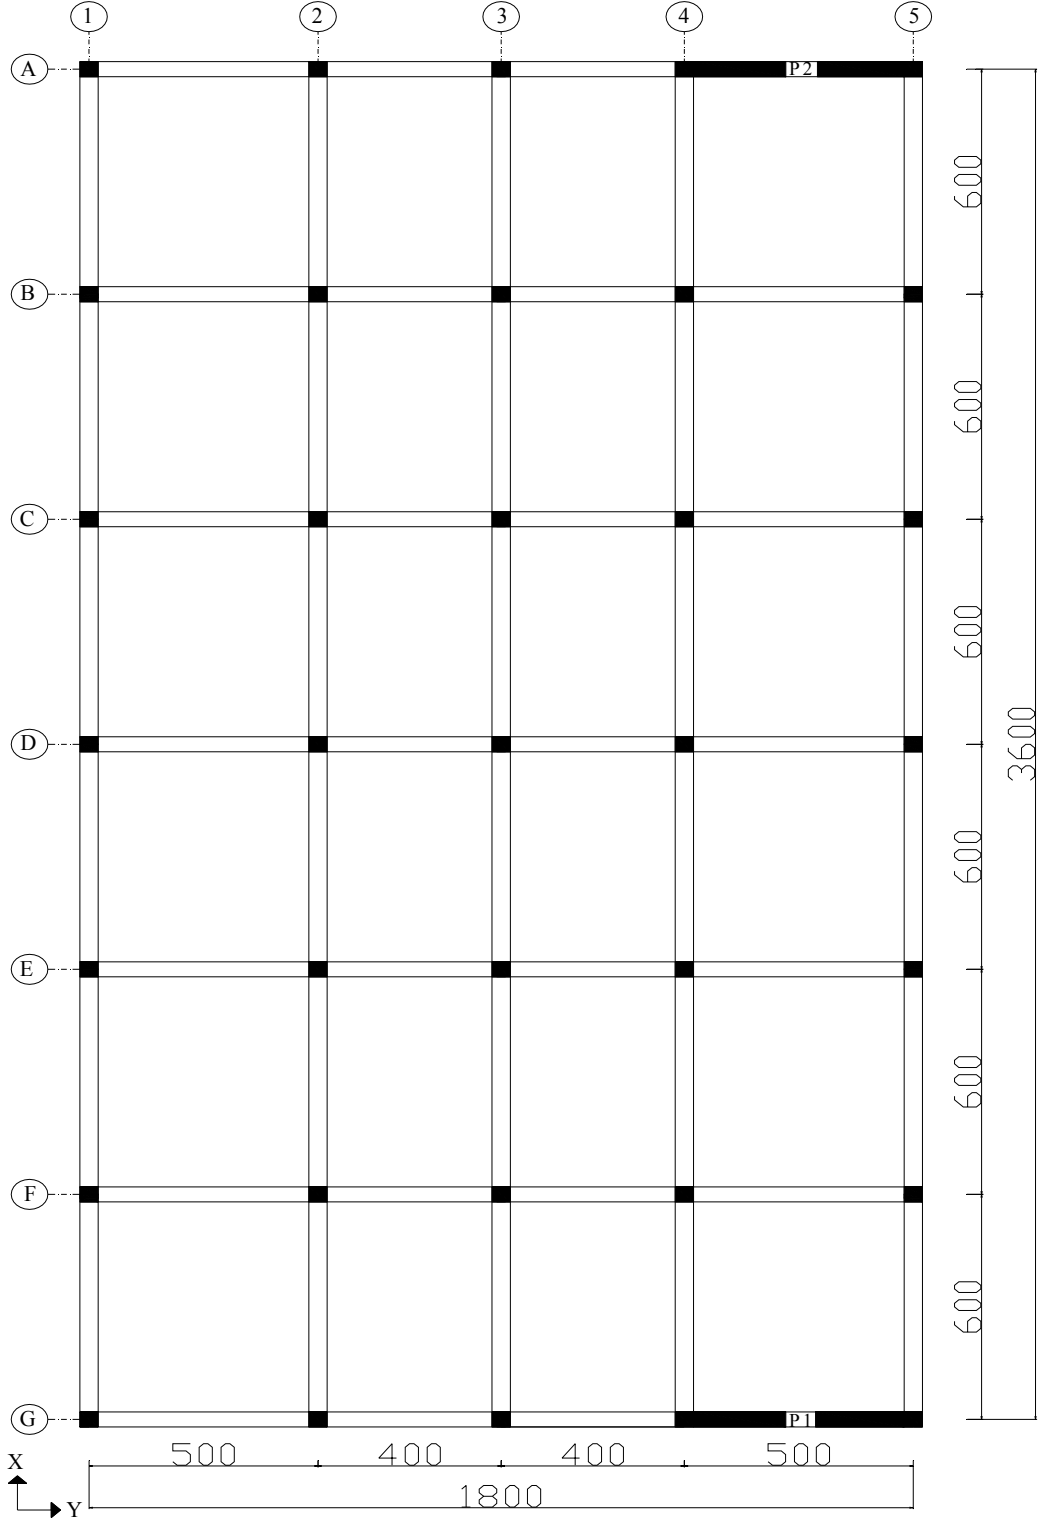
Örnek 5.4 'ün kat kalıp planı
